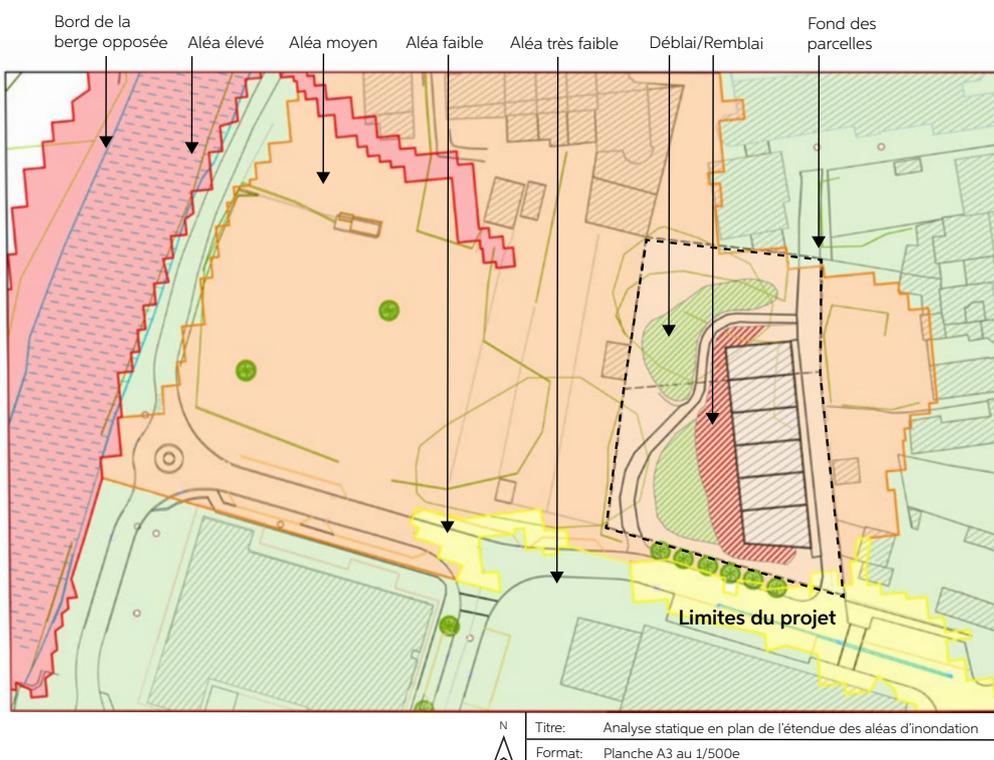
Analyse statique en plan dans le cas d'un aléa d'inondation par débordement.
